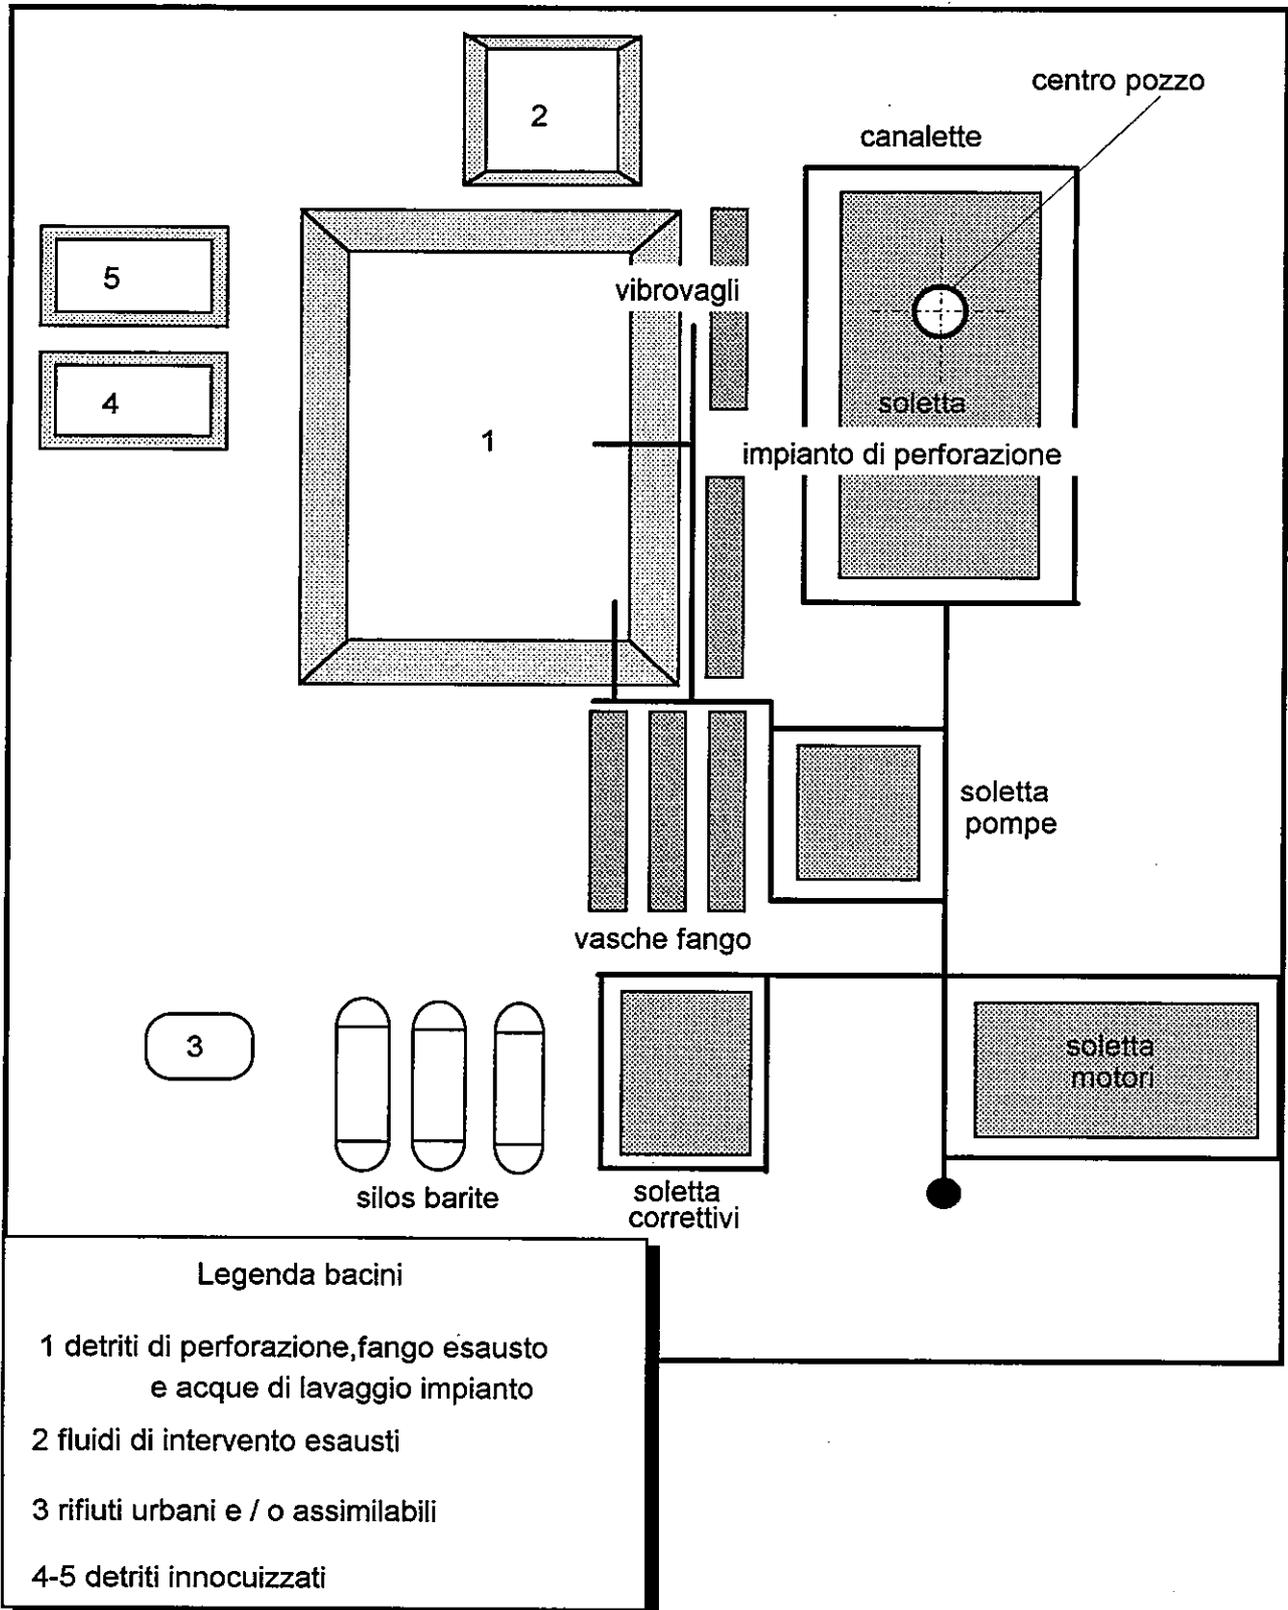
PLANIMETRIA POSTAZIONE
